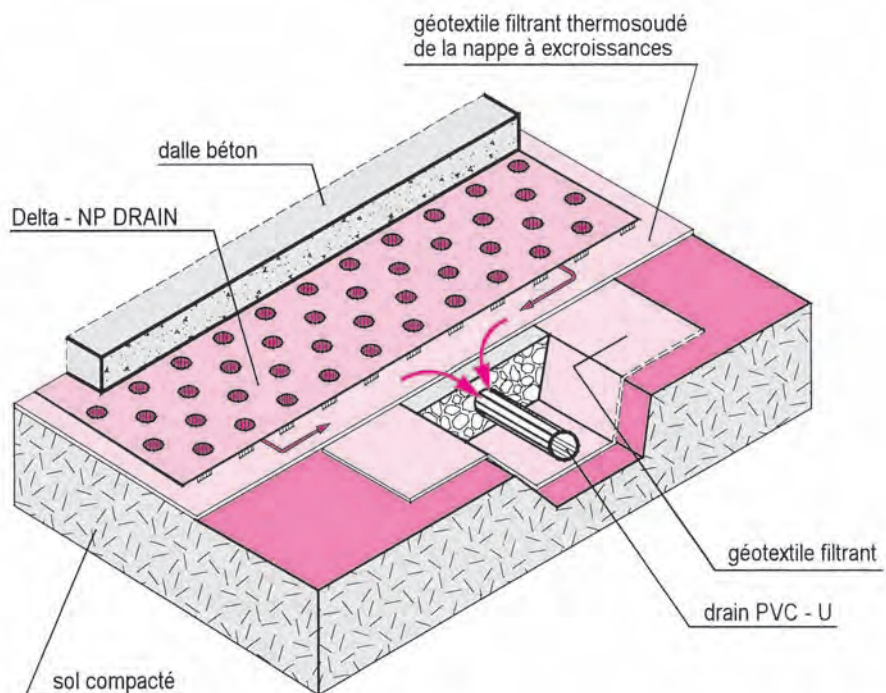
Schéma de drainage sous dalle en béton armé avec nappes Delta-NP Drain
